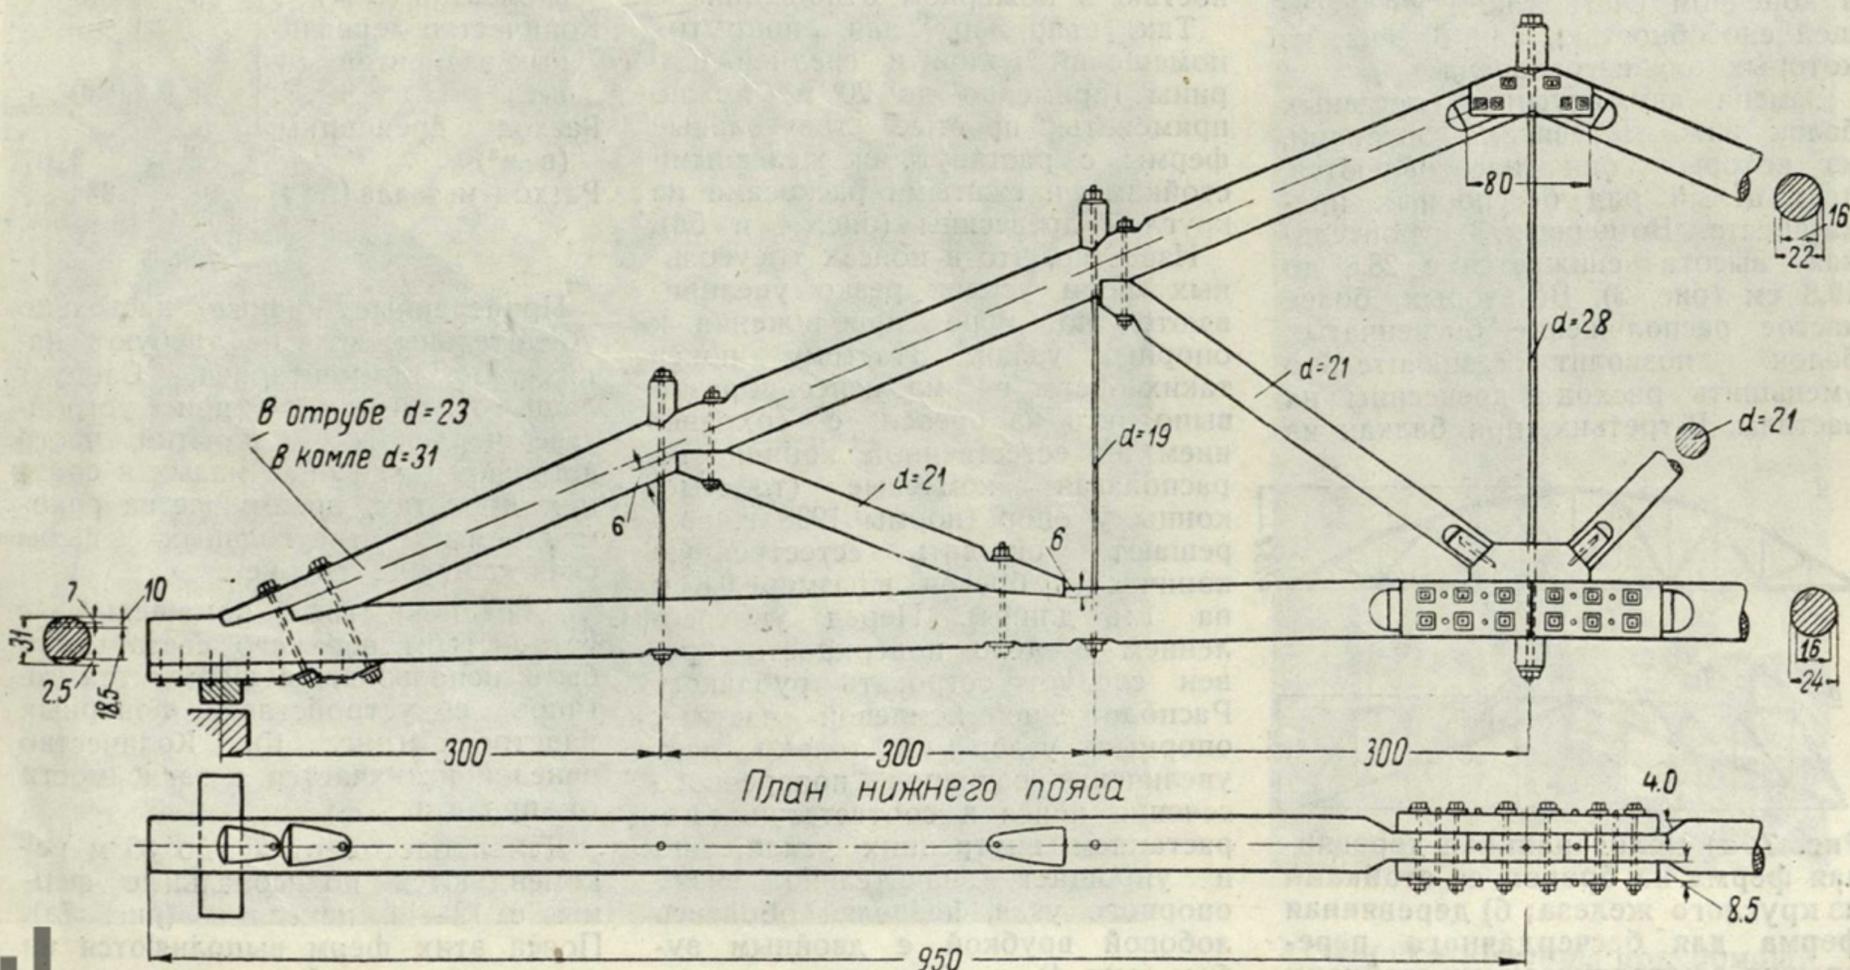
Узловые сопряжения в треугольной ферме из круглой древесины
